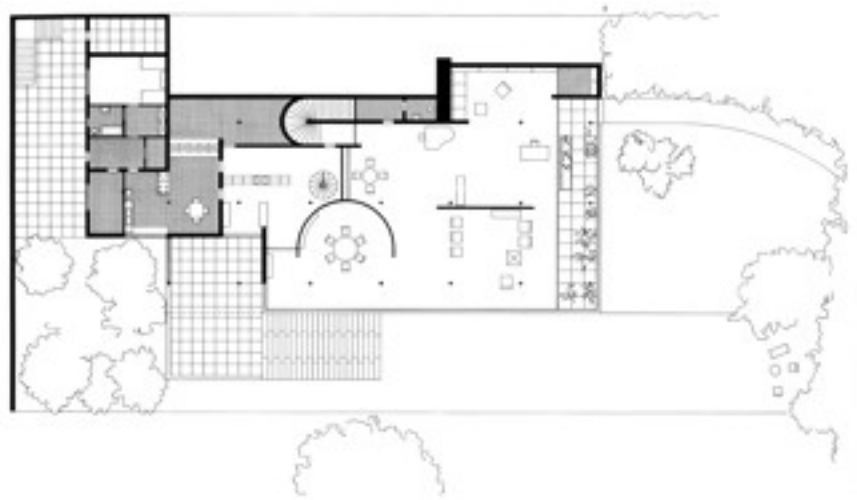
Haus Tugendhat, Grundriss EG
